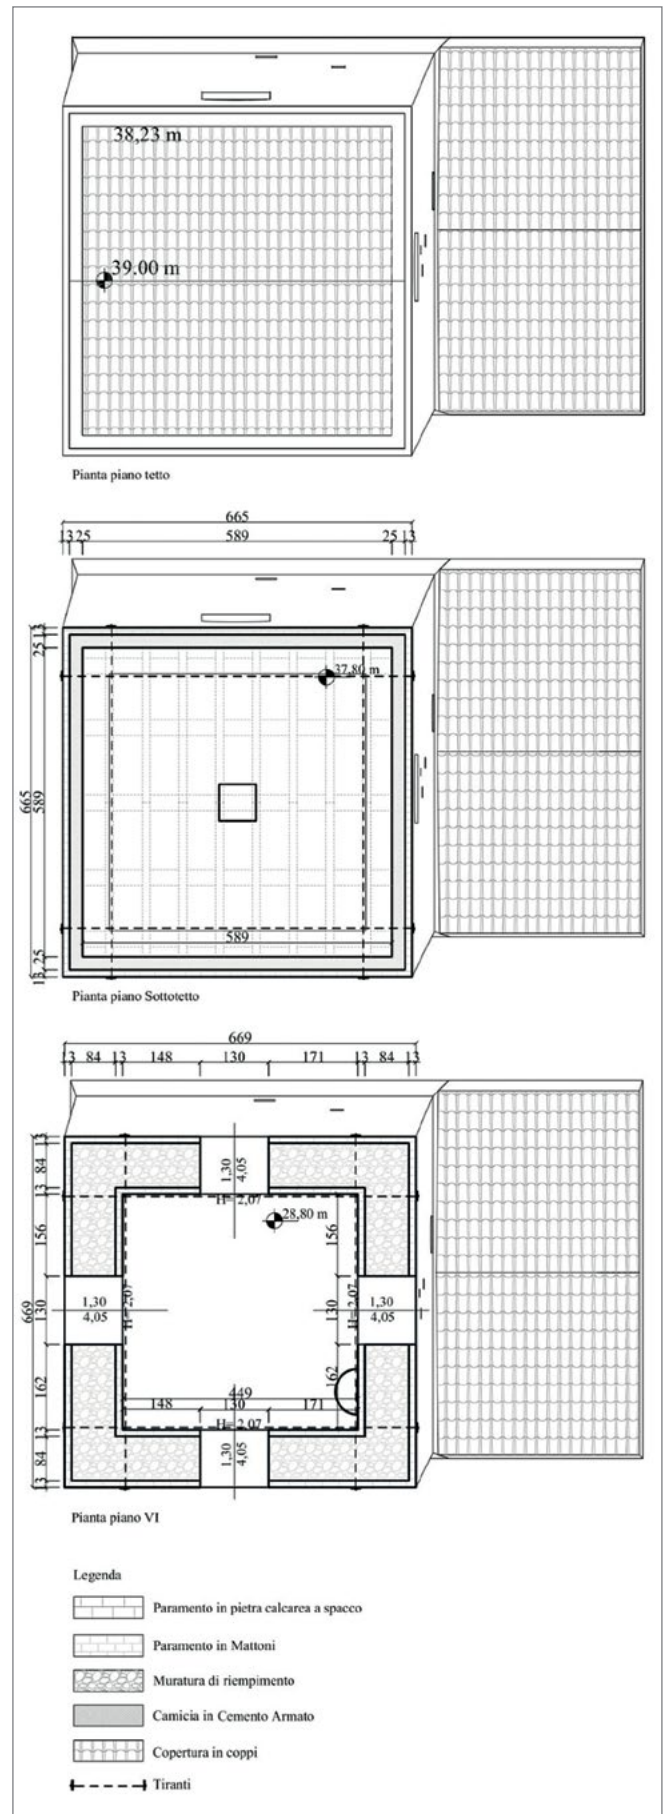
Pianta tetto, sottotetto e piano 6 della Torre degli Smeducci.
